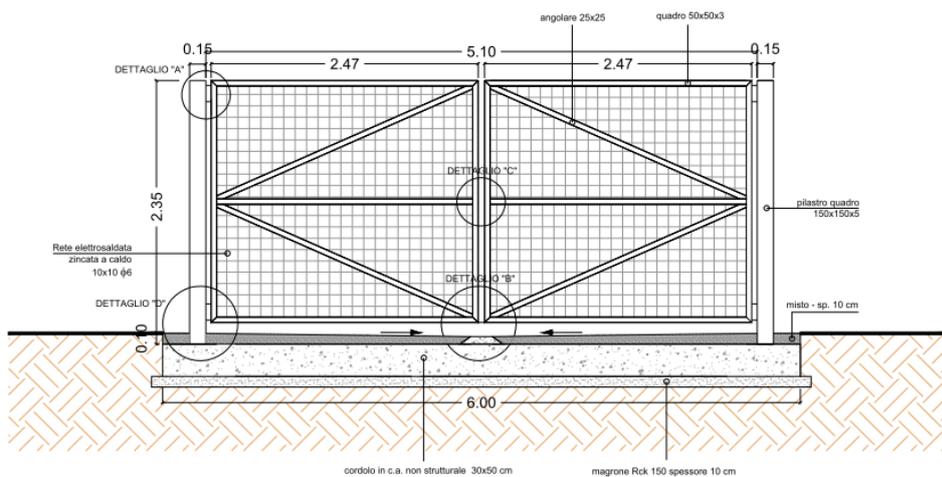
Cannello di ingresso ai campi fotovoltaici, schema tipo (estratto PRO\_TAV\_23)
